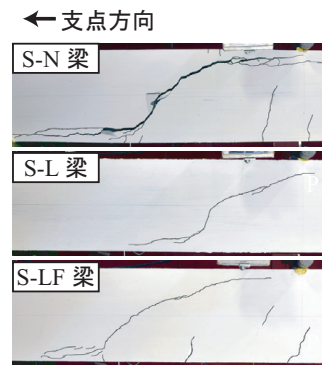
S 梁に関する荷重低下直後のひび割れ性状
